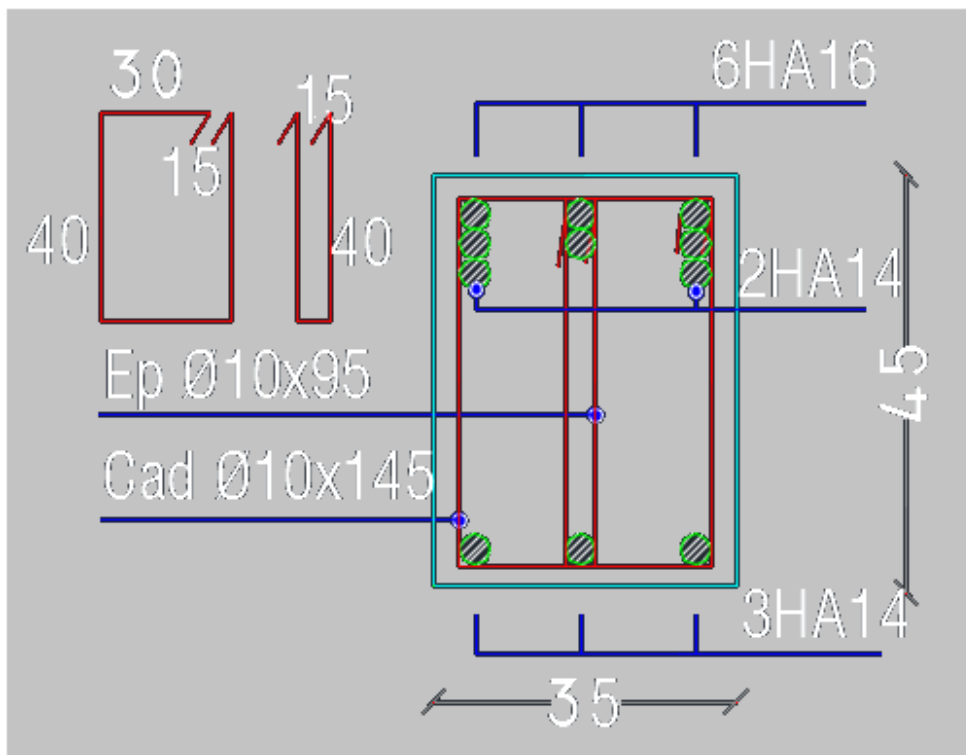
Ferrailage des poutres principales au niveau d'appuis de 14<sup>ème</sup> et 15<sup>ème</sup> étage.
